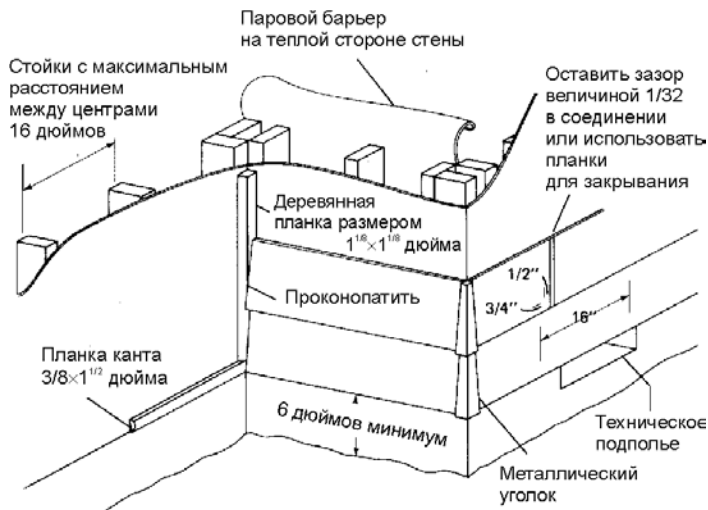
Внутренние углы могут быть отделаны деревянными планками с прямоугольными краями (Boise-Cascade)
